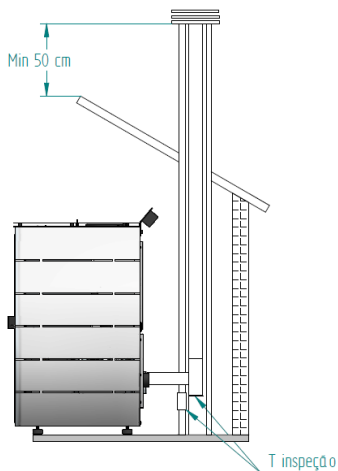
Vista lateral da instalação com chaminé, com exemplo do ponto de inspeção.
